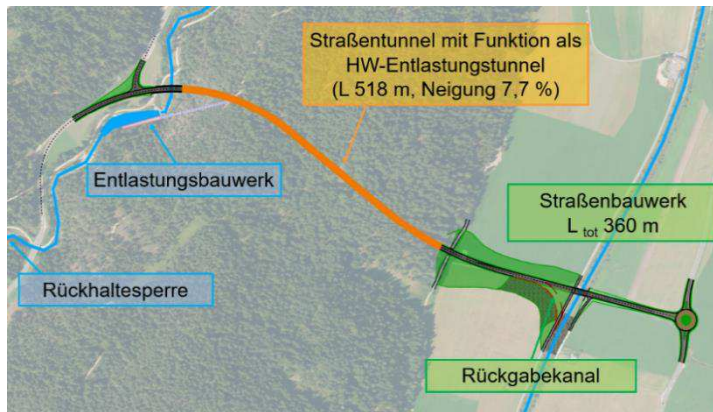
Lageplan der Hauptbauwerke des Projektes.
